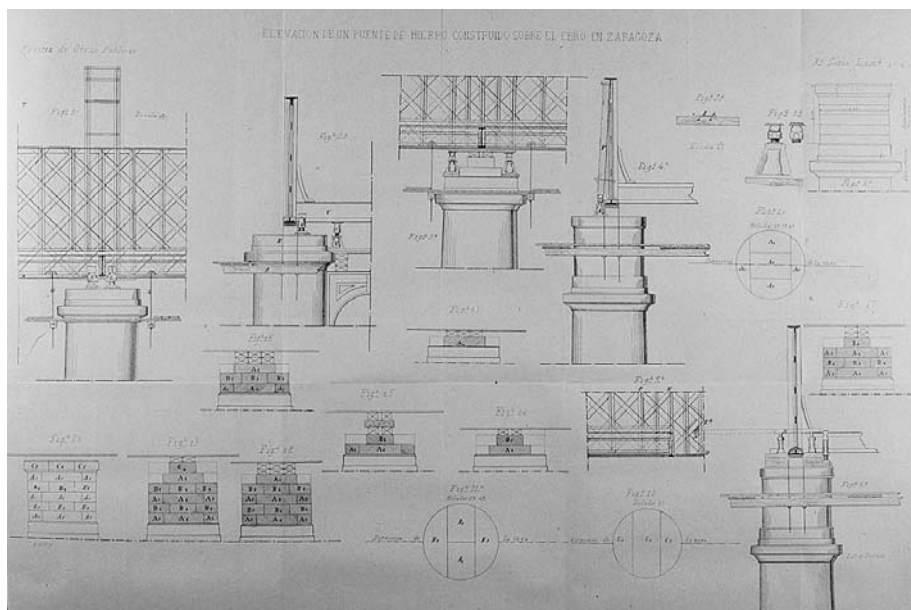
Proyecto de elevación de un puente de hierro construido sobre el río Ebro en Zaragoza, 1880.
